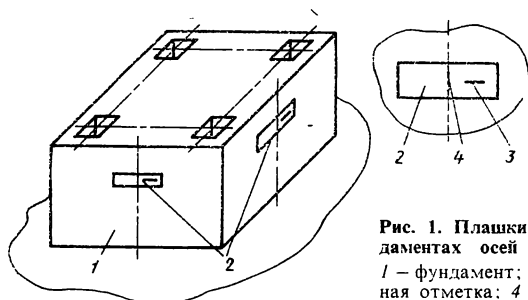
Плашки для нанесения на фундаментах осей и высотных отметок: 1 — фундамент; 2 — плашка; 3 — высотная отметка; 4 — осевая отметка
